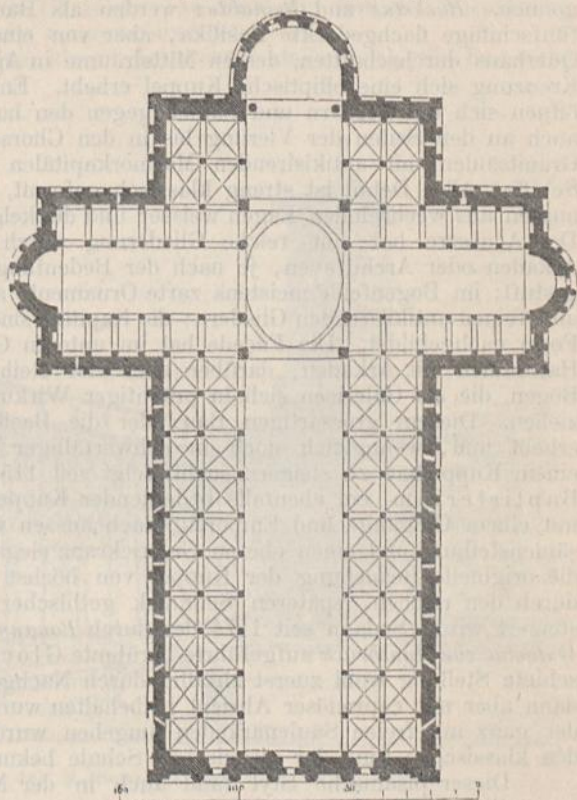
Grundriss des Doms zu Pisa.
